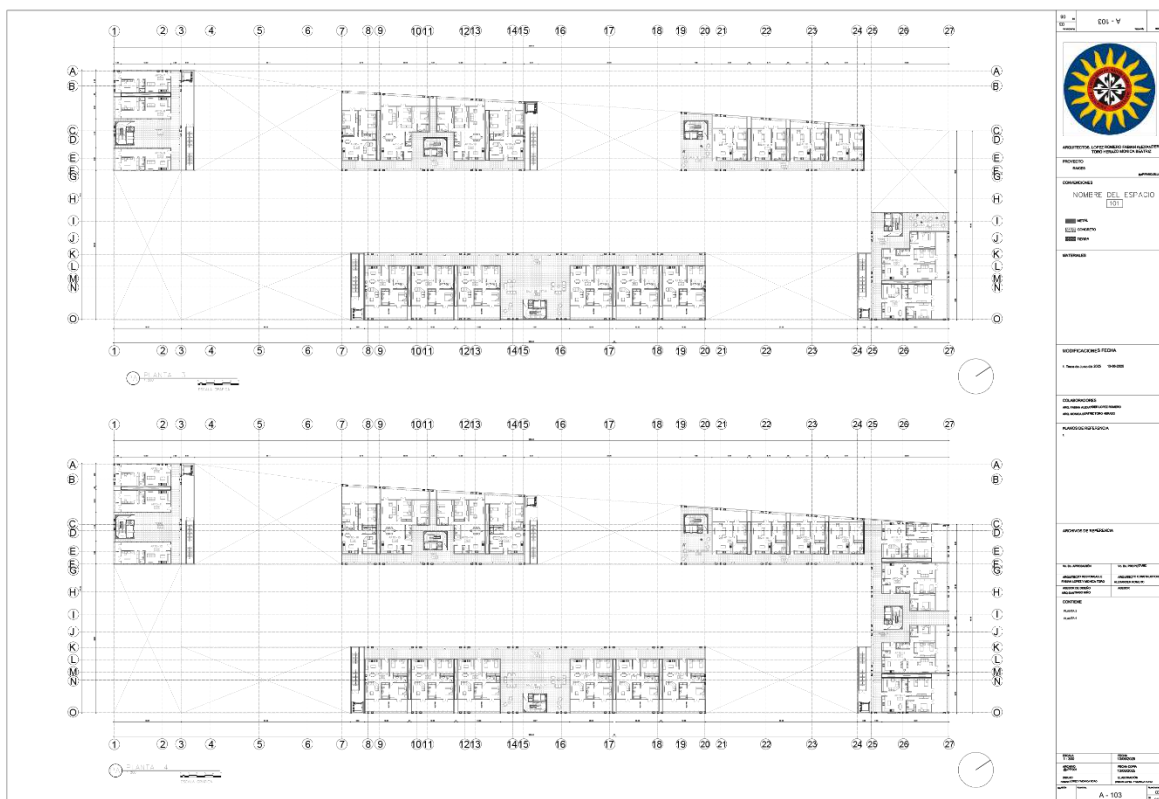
Planimetría Planta 3-4. Fuente: Elaboración propia.
